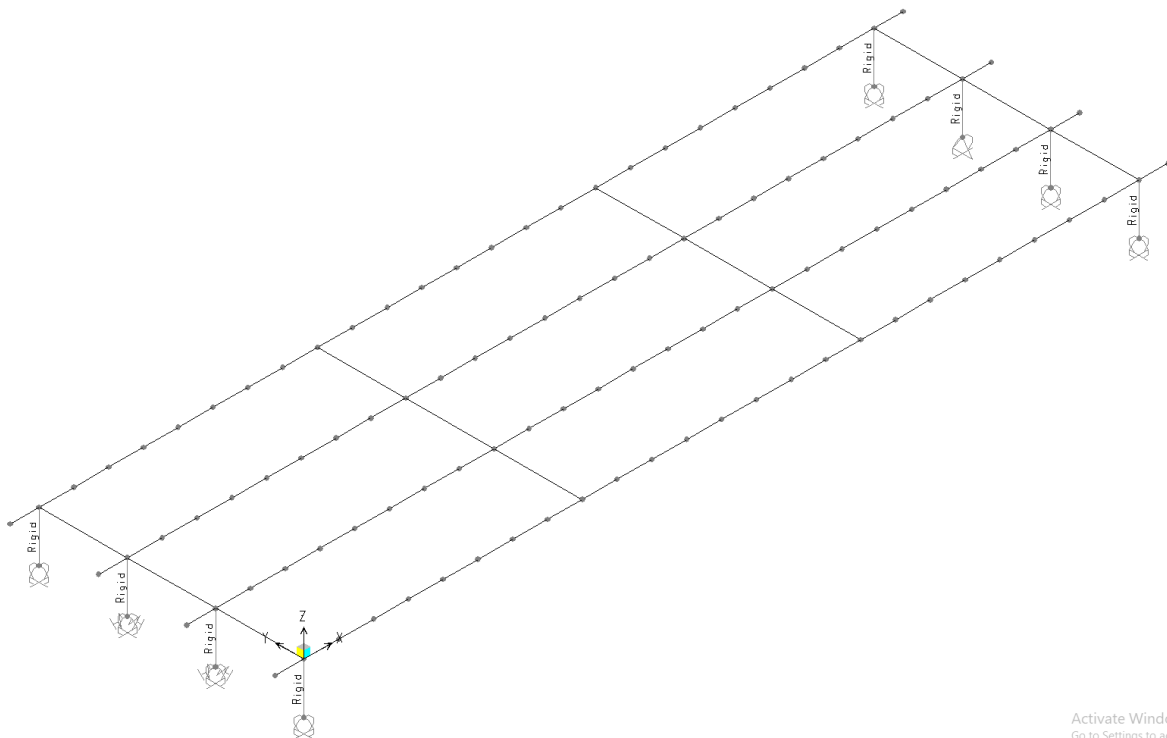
Modello 2 – elementi BEAM che schematizzano la soletta in direzione trasversale
